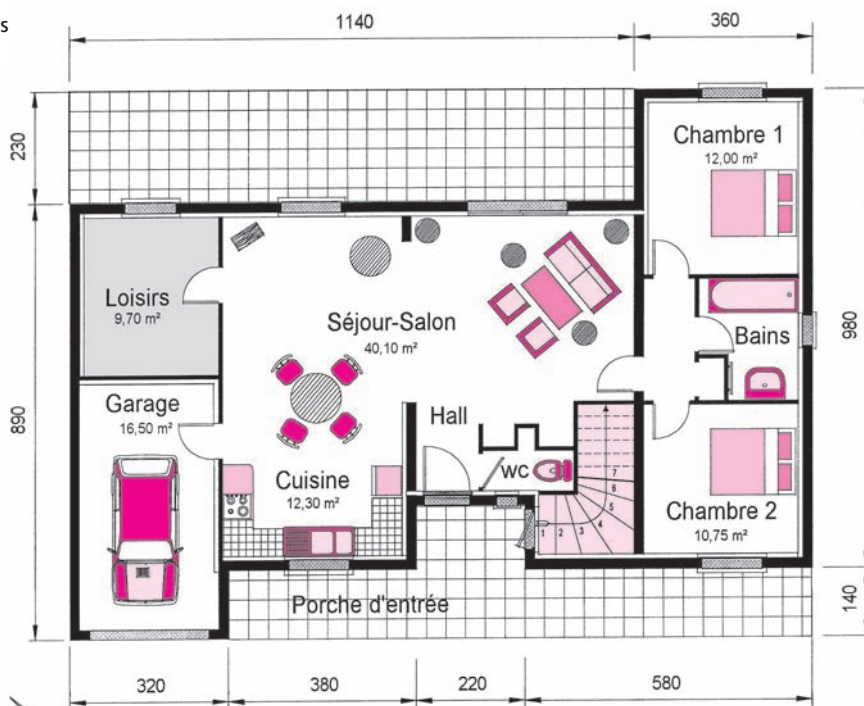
Disposition schématique des locaux du rez-de-chaussée
